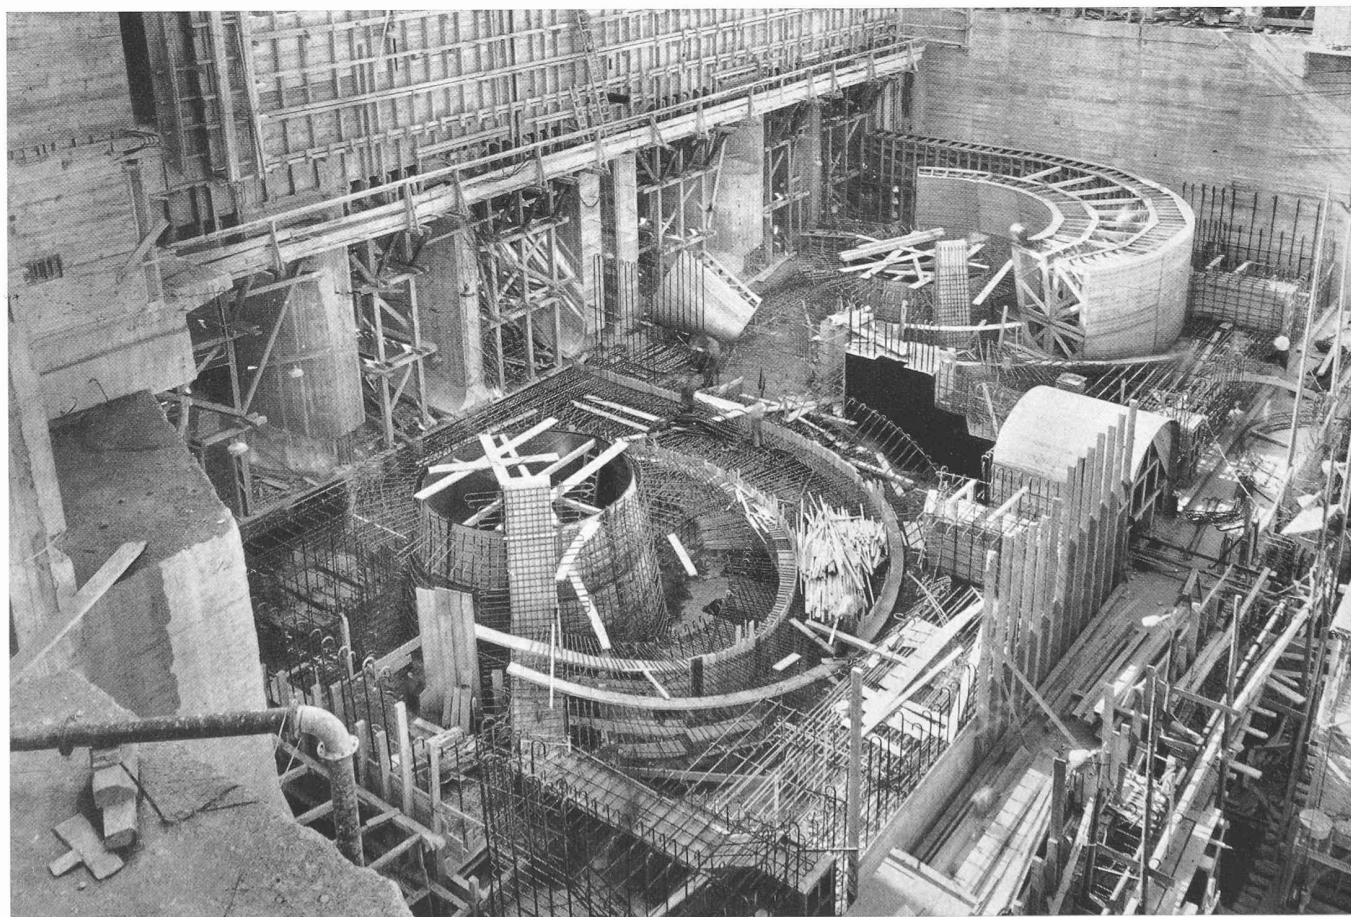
Maschinenhausbaugrube am 26. Juli 1944. Armierung des Spiralbodens der SBB-Turbine. Spiralschalung der NOK-Turbine
